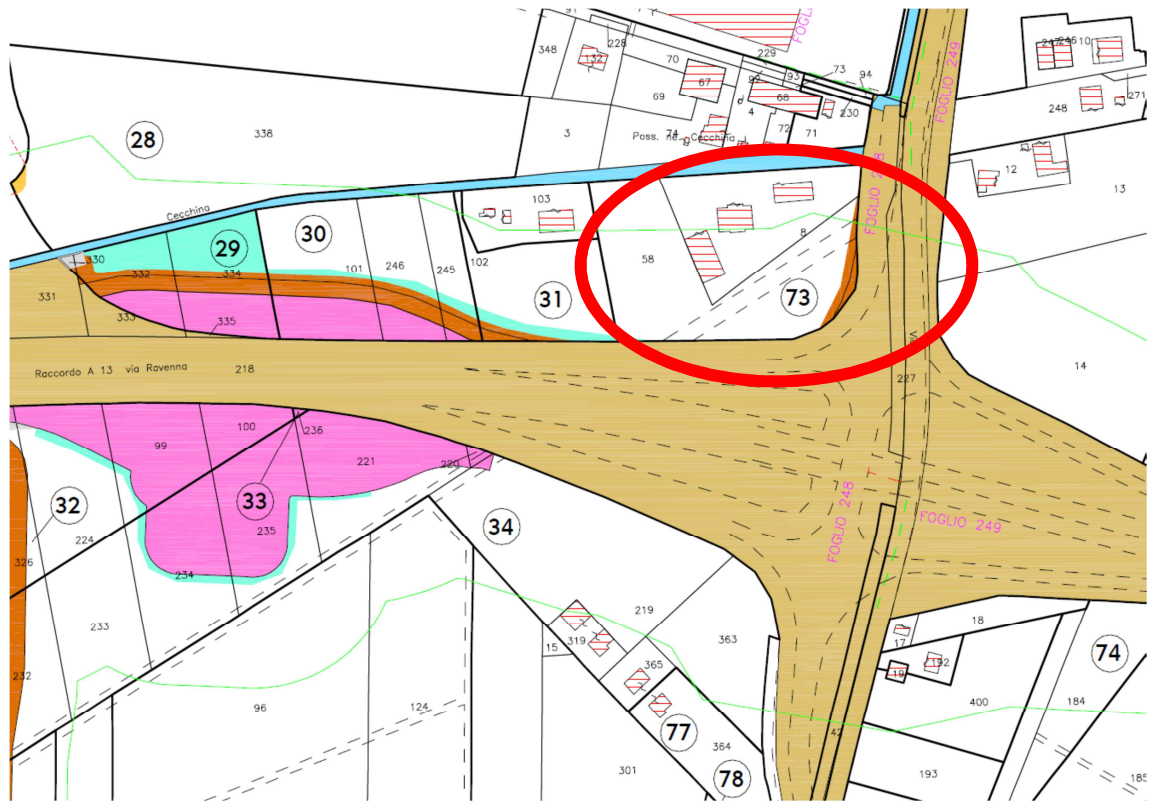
PLANIMETRIA CATASTALE
